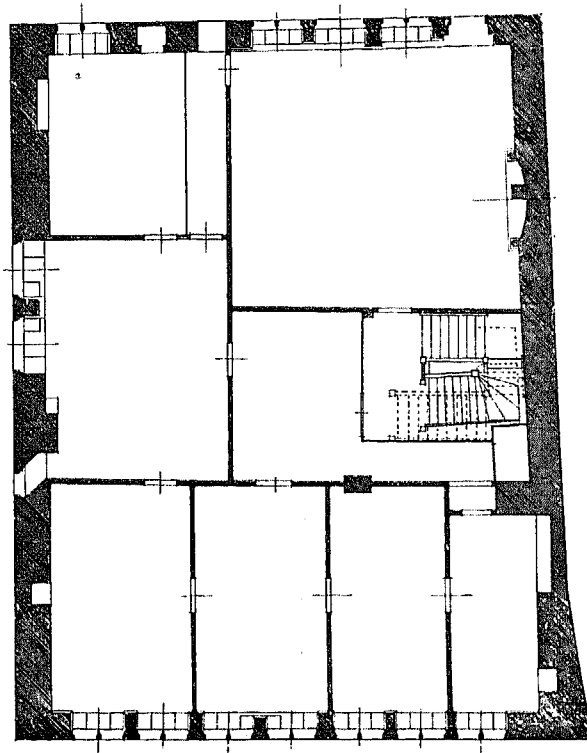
Steinernes Haus; erstes Obergeschoss.
